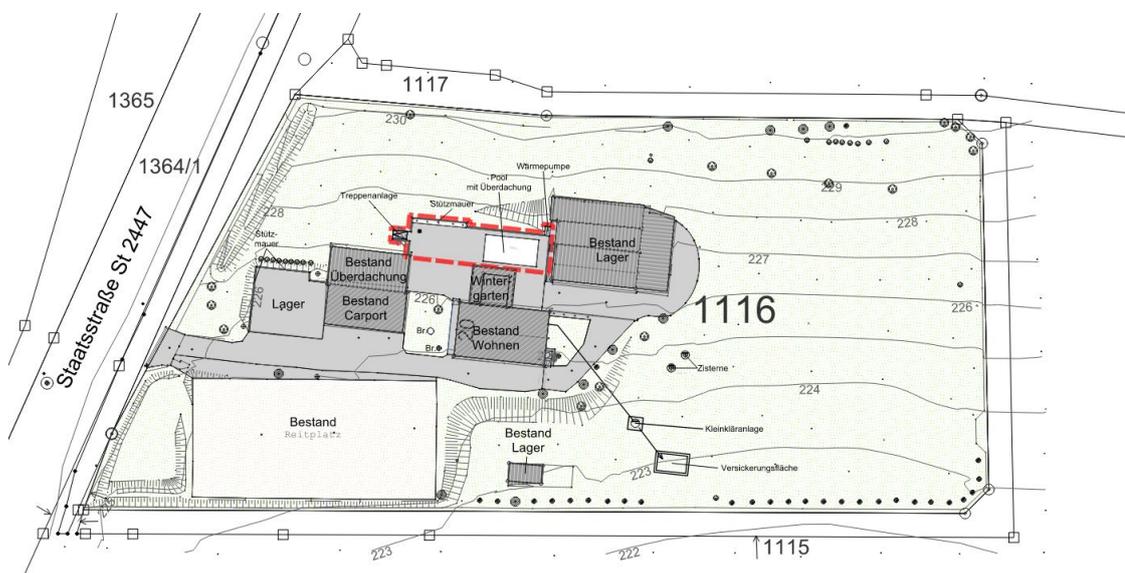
Übersicht Plangebiet und bestehende bauliche Nutzung- Flurstücks-Nr. 1116 , Planbereich rot umrandet
